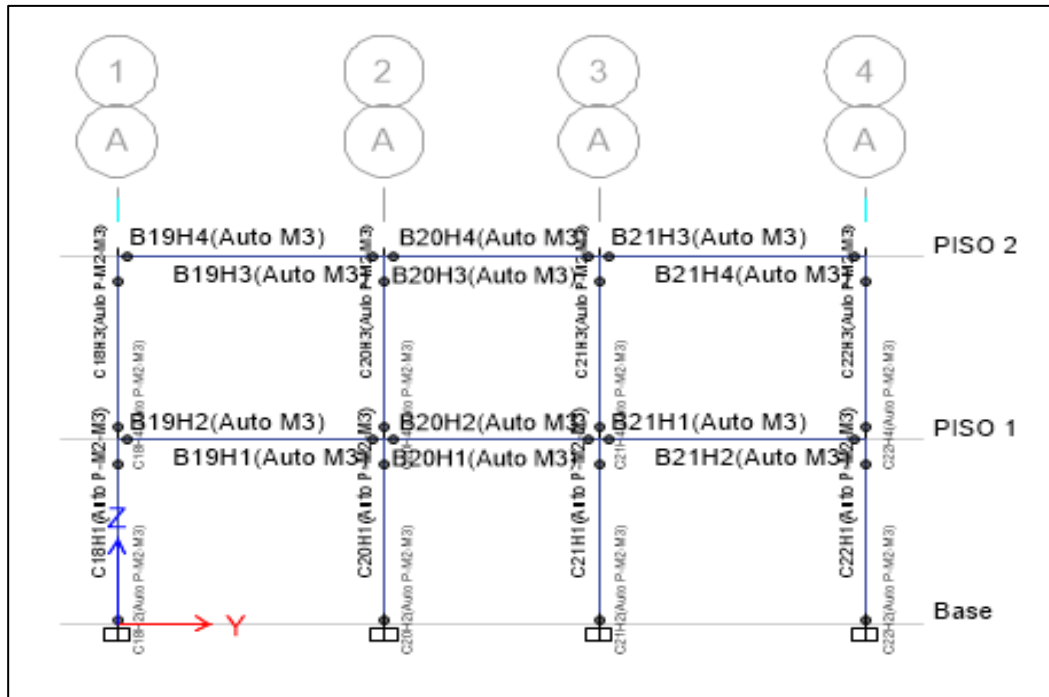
Ubicación de las rótulas plásticas en las columnas en el eje y-y. Fuente: Elaboración propia.
